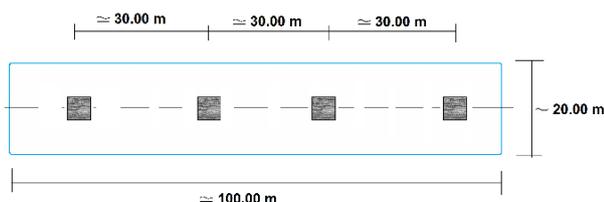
Planta esquemática de la superficie a cubrir por la cubierta. Fuente: SENER Ingeniería
